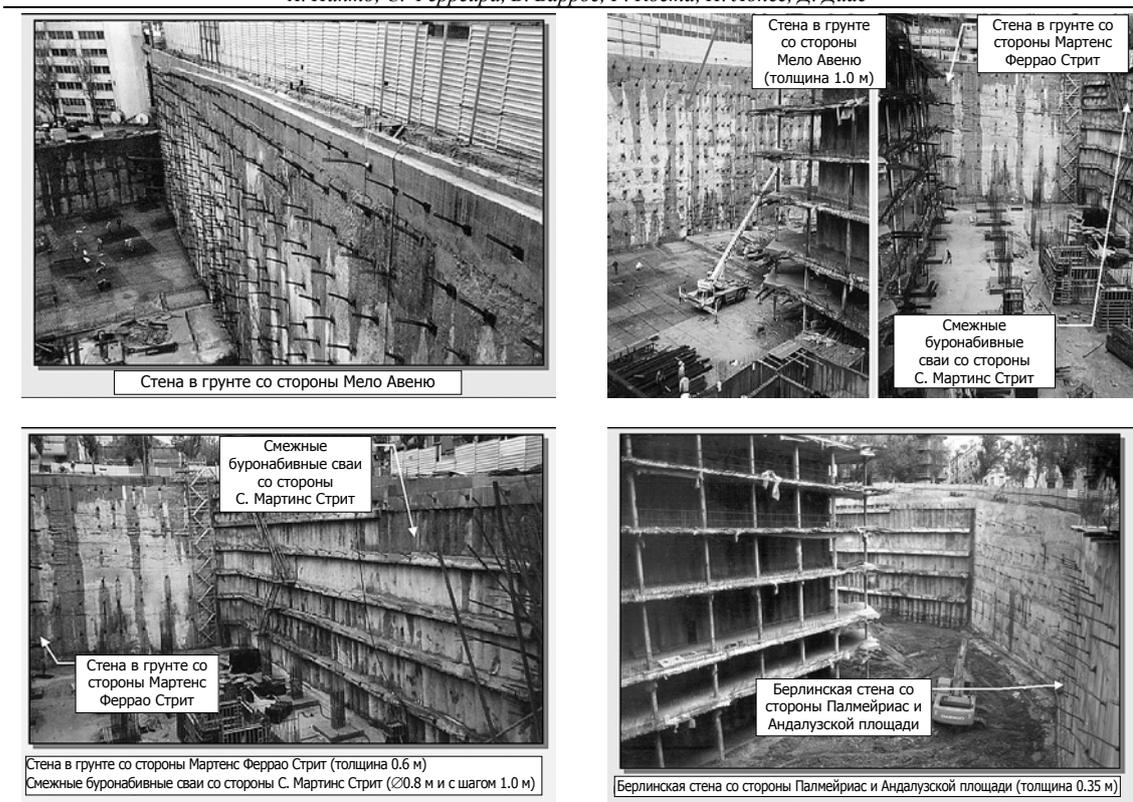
Вид внешних стен на стадии завершения работ в котловане
